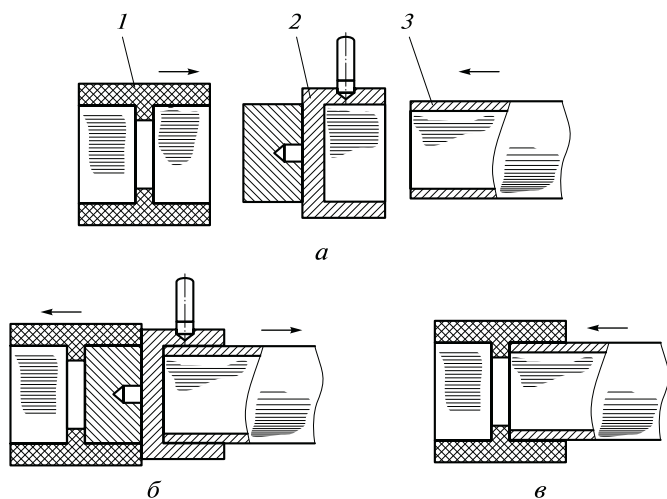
Соединение сваркой полиэтиленовой муфты с трубой:
